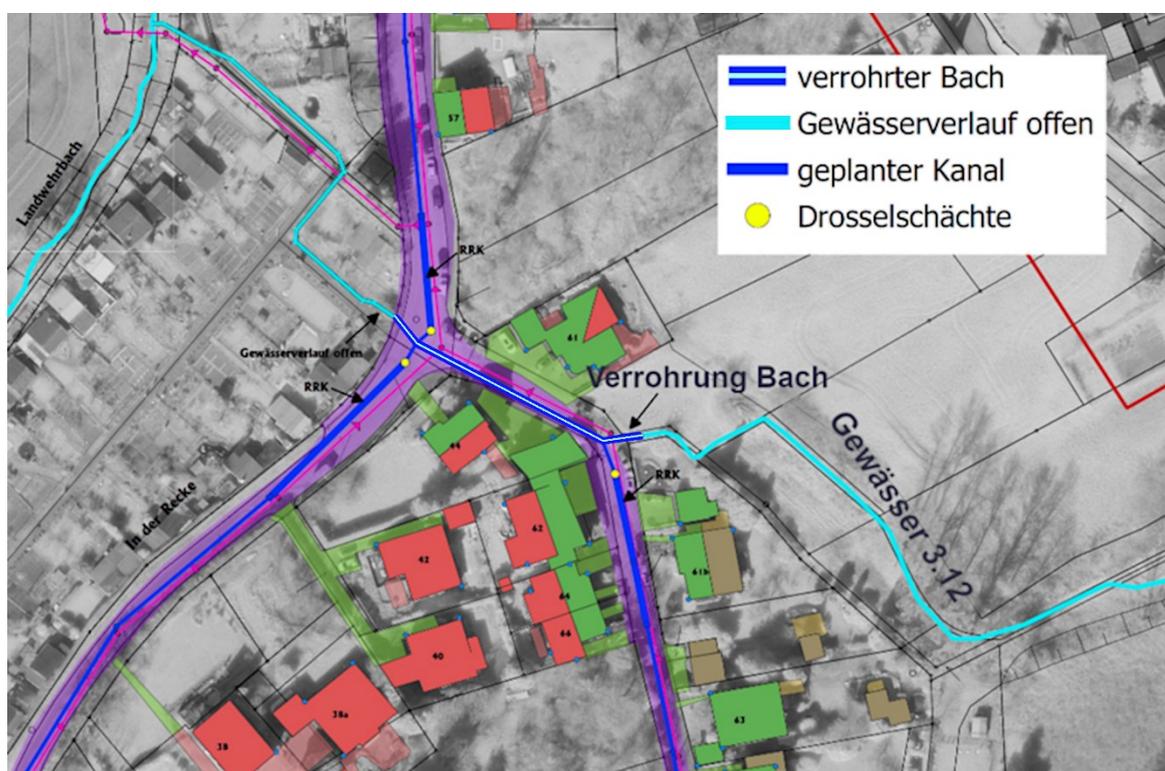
Planung Entflechtung des Gewässers 3.12
